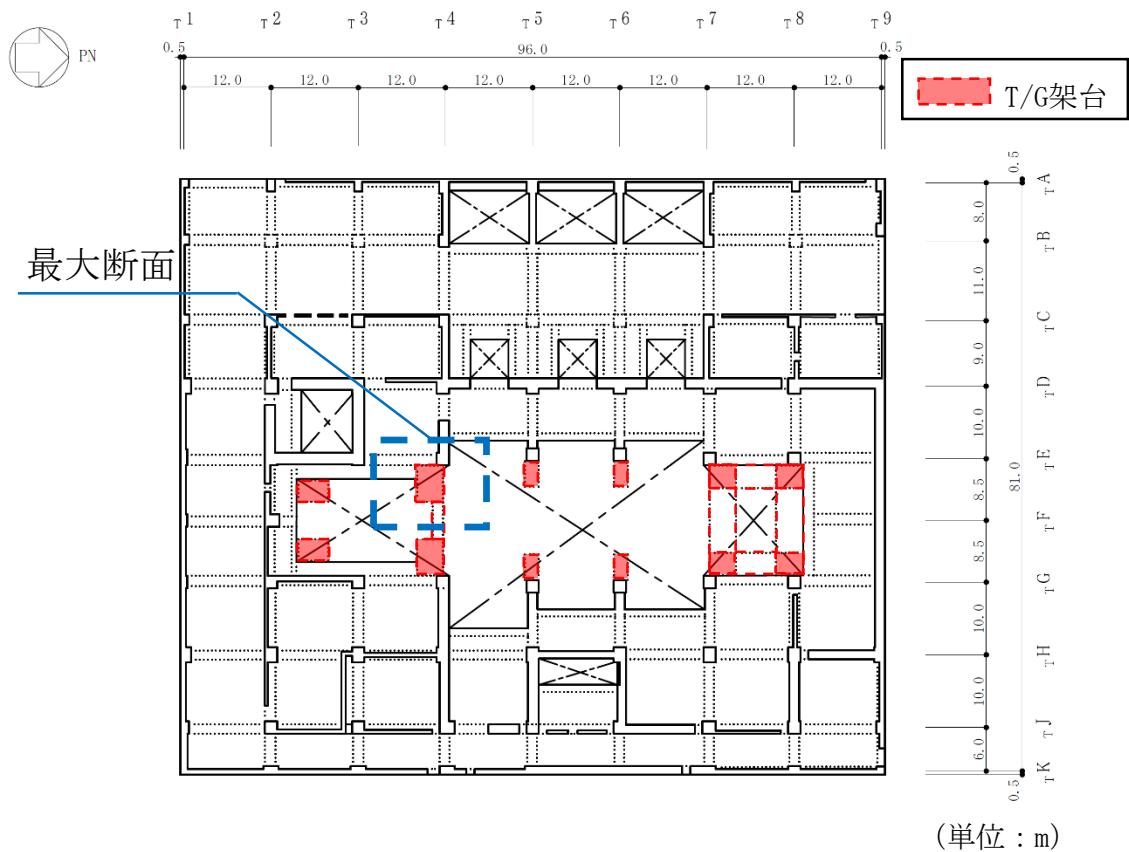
モデル化部の平面図（1F, T. M. S. L. 12.3m）
